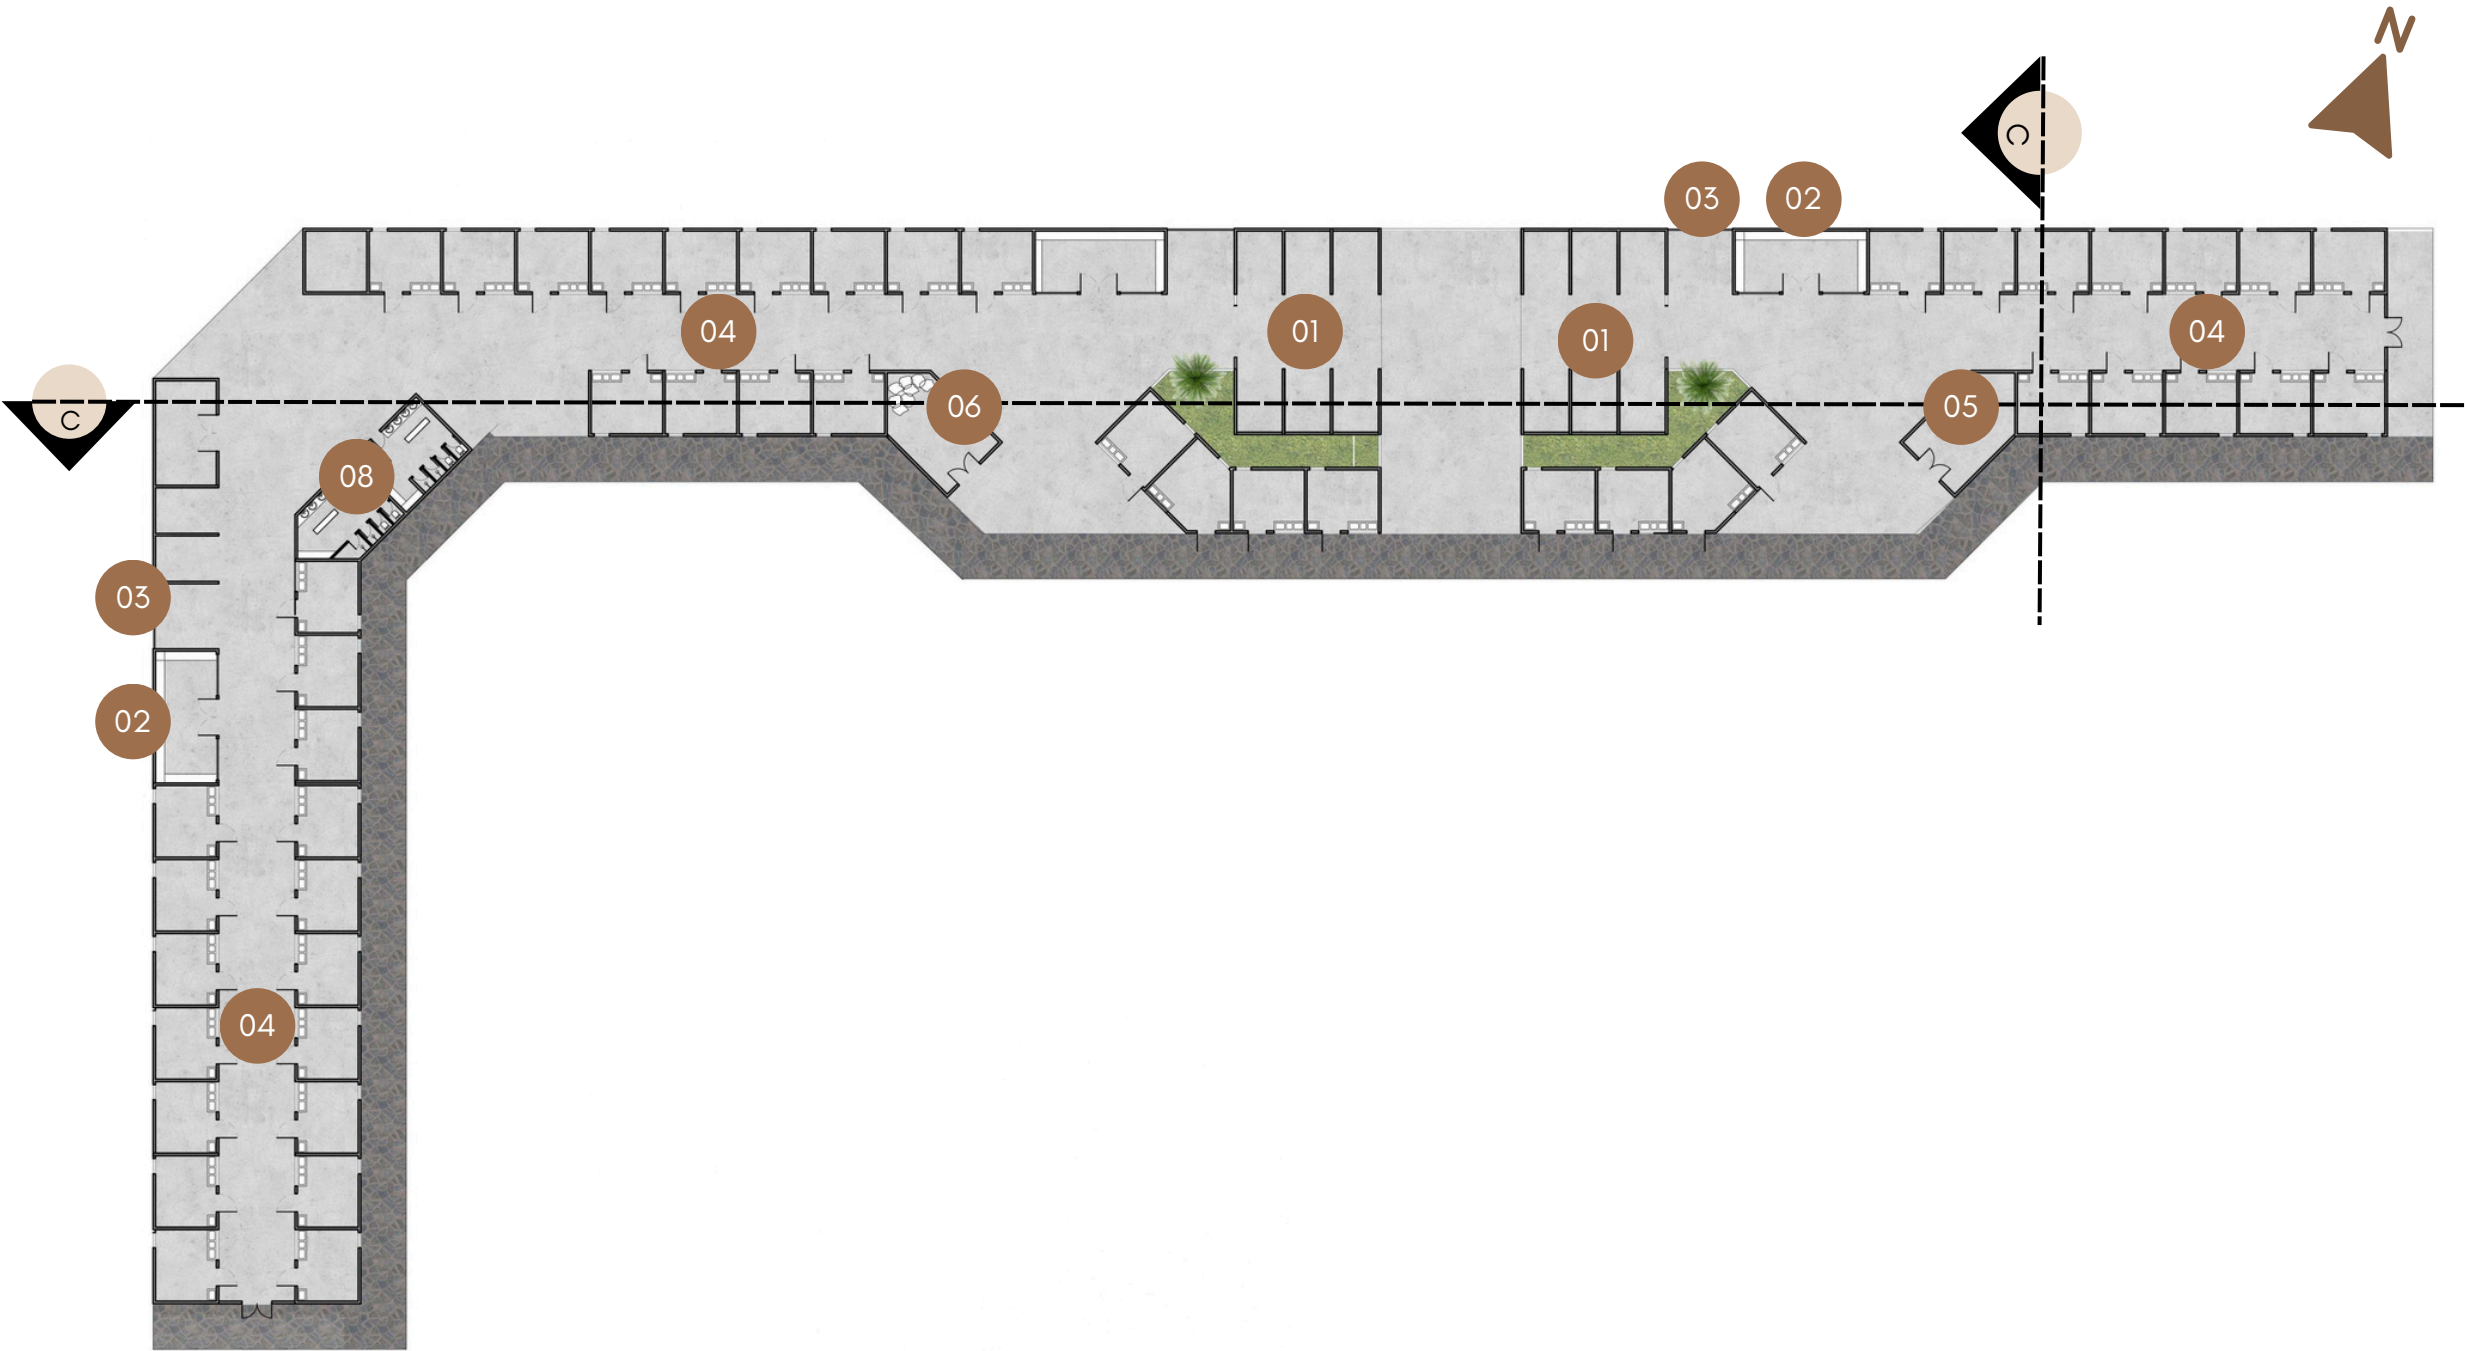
Planta Bloco 02 / Fonte: Elaborado pela autora em 2024
